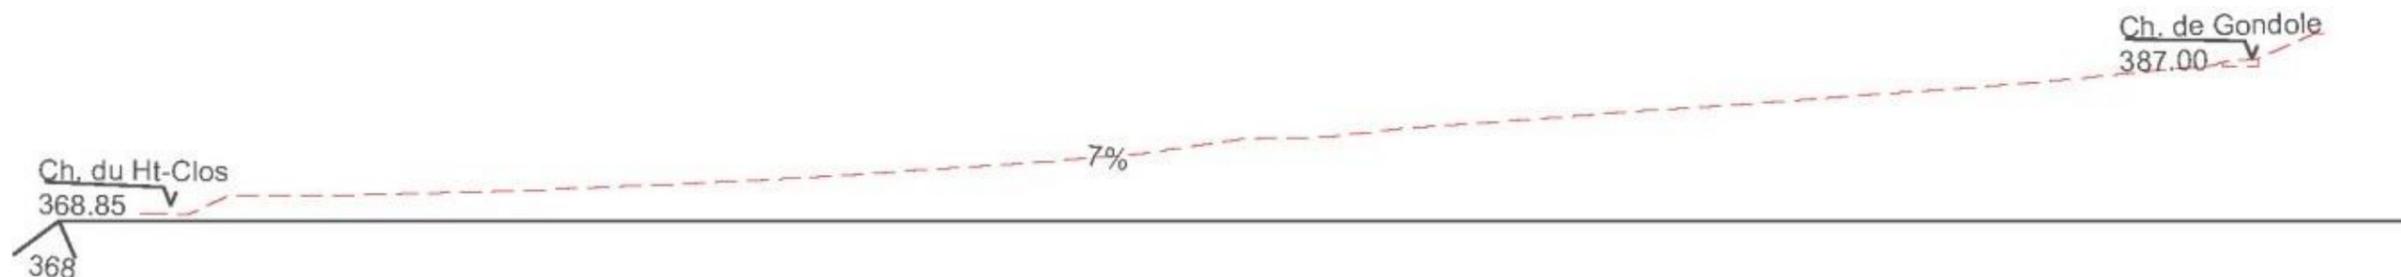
Coupe Est-Ouest au Sud du site (BB')
